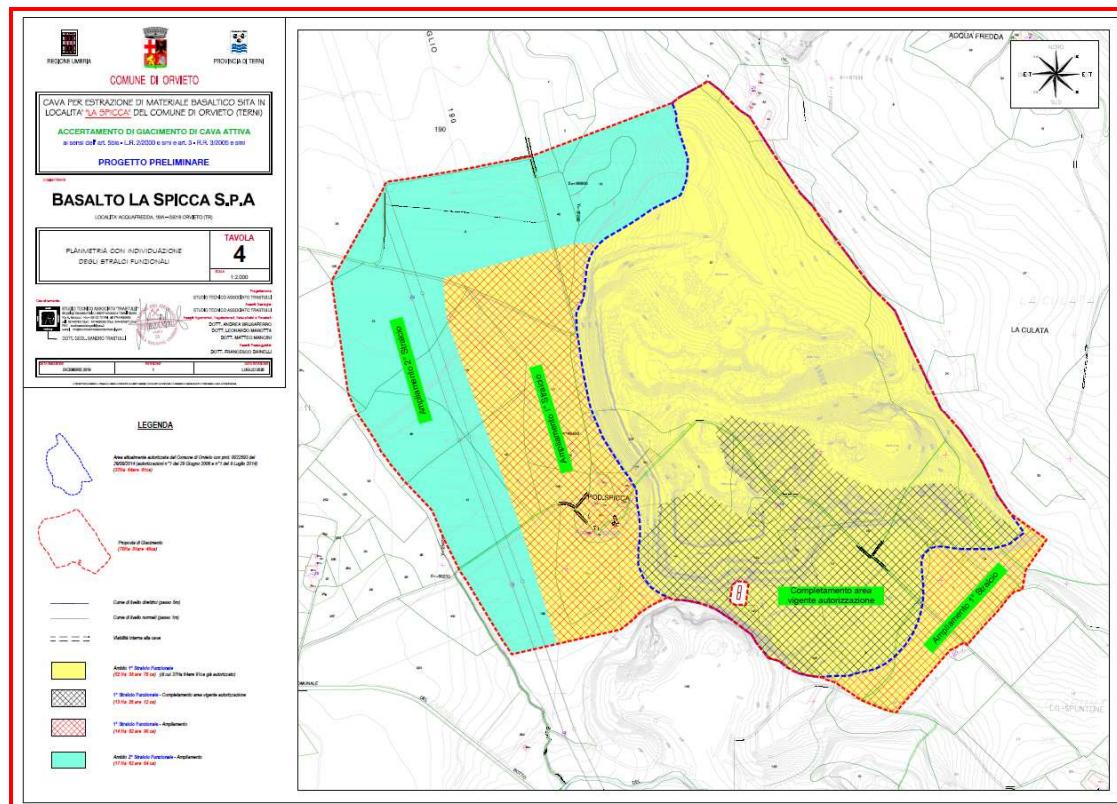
Stralcio Tav.4 Progetto Preliminare – individuazione Stralci Funzionali
